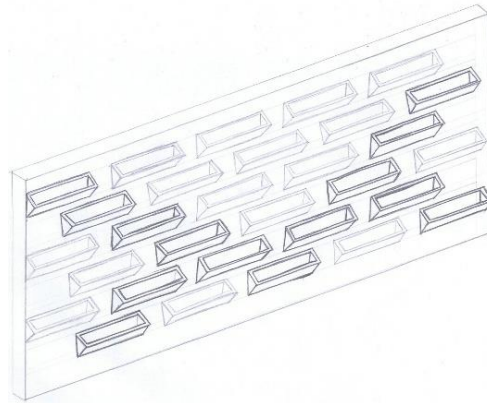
Peças individuais para pequenas plantas penduradas em parede
